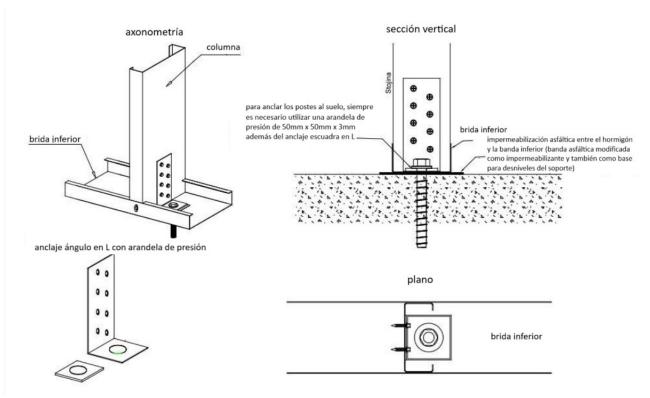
axonometría, sección vertical y vista en planta del anclaje de los soportes de la estructura de armazón de muro
